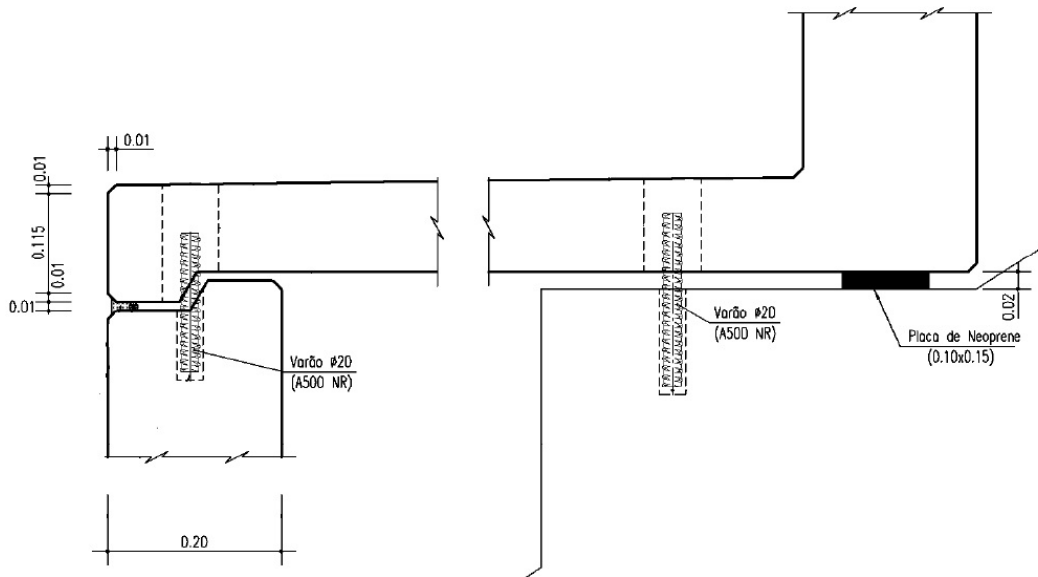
Esquema de um Elemento Pré-Fabricado do Novo Estádio dos Barreiros [34]
